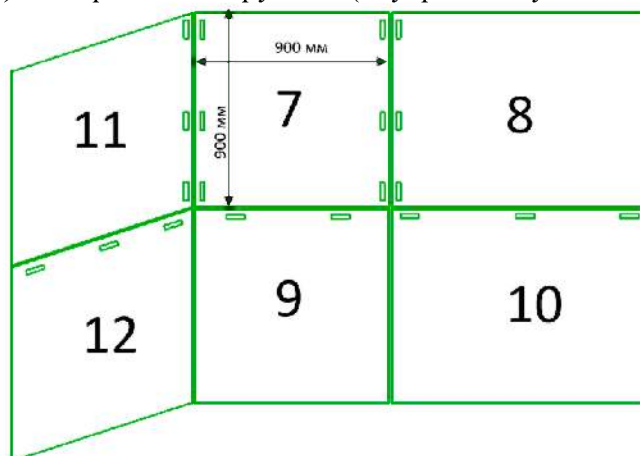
Собранная конструкция из щитов опалубки с внутренними углами
